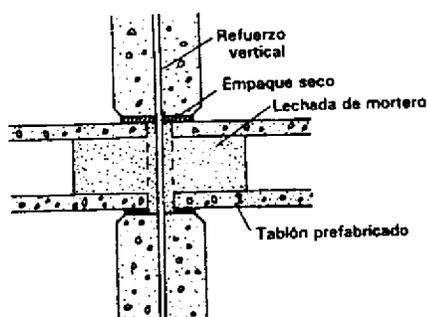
Conexión muro-losa (Wakabayashi, 1986).
